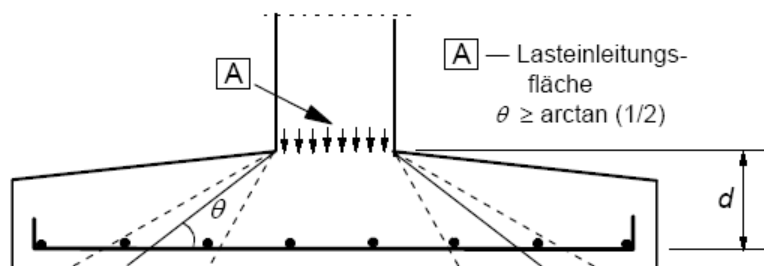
Rundschnitt in Fundament mit veränderlicher Dicke
